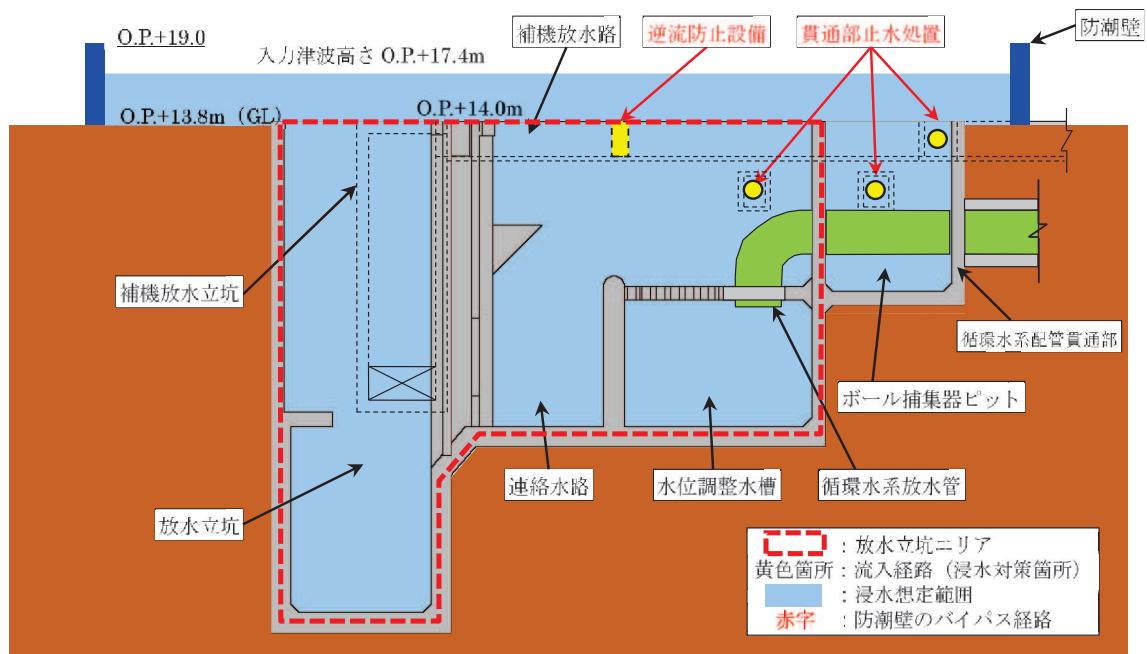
第 2 号機 放水立坑 浸水対策配置図 (B-B 断面図)
